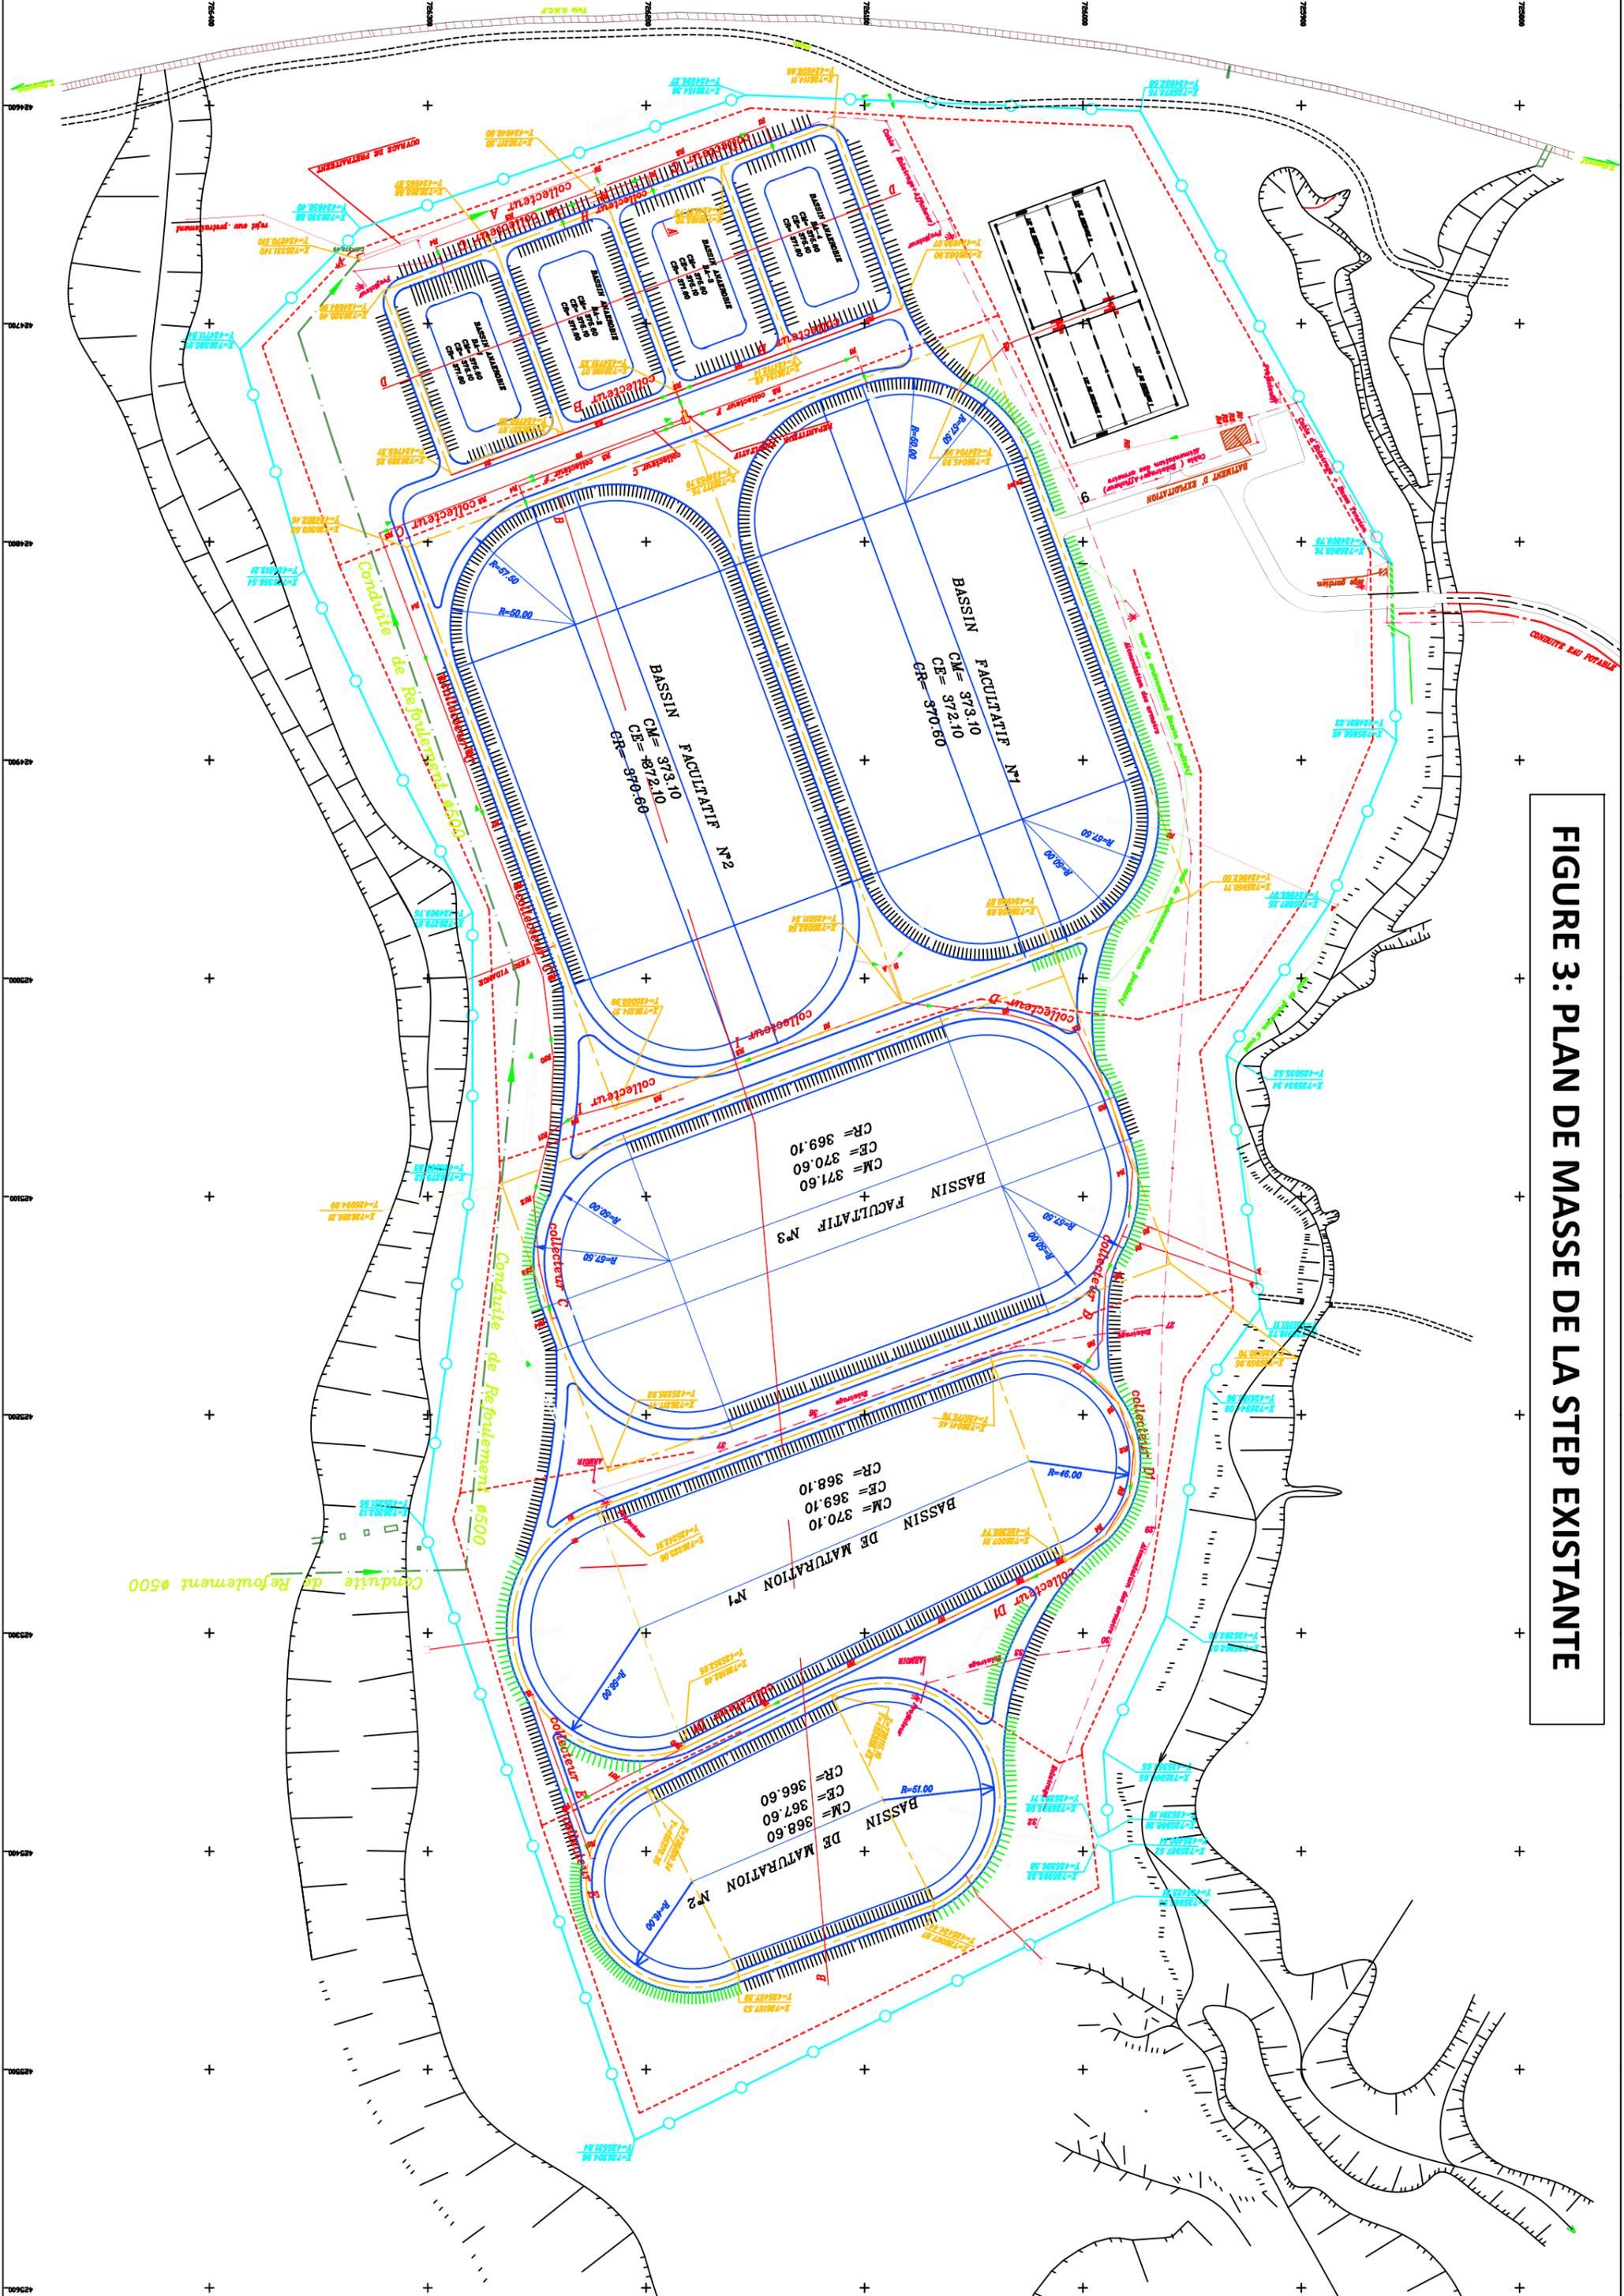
PLAN DE MASSE DE LA STEP EXISTANTE
